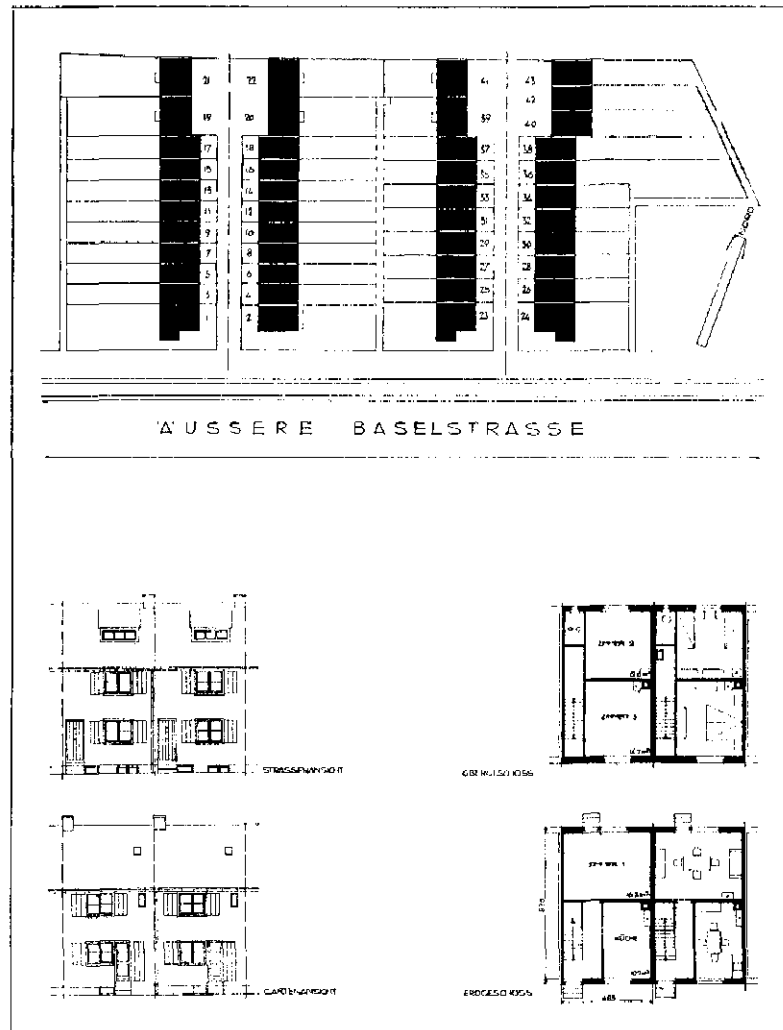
62 | Basel | Einfamilienhäuser Habermatten | Architekten: Artaria und Schmidt, Basel | Lageplan der Siedlung | Ansichten und Grundrisse der Häuser
